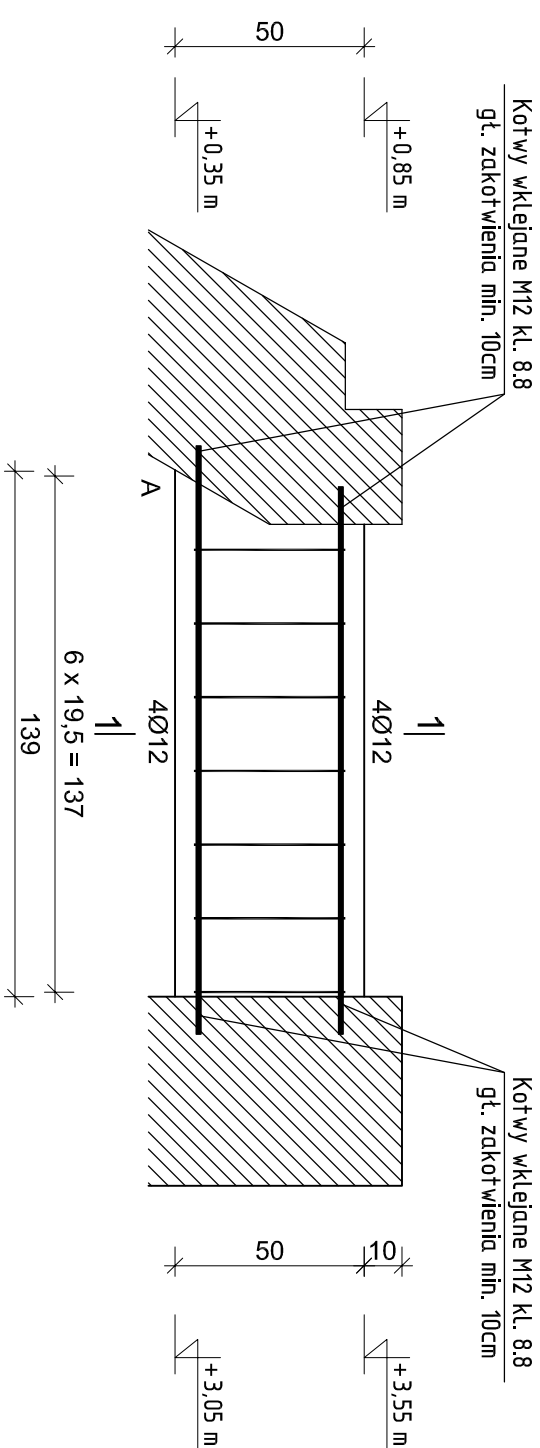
Poz. 4.1, Poz. 4.2 – Belki
